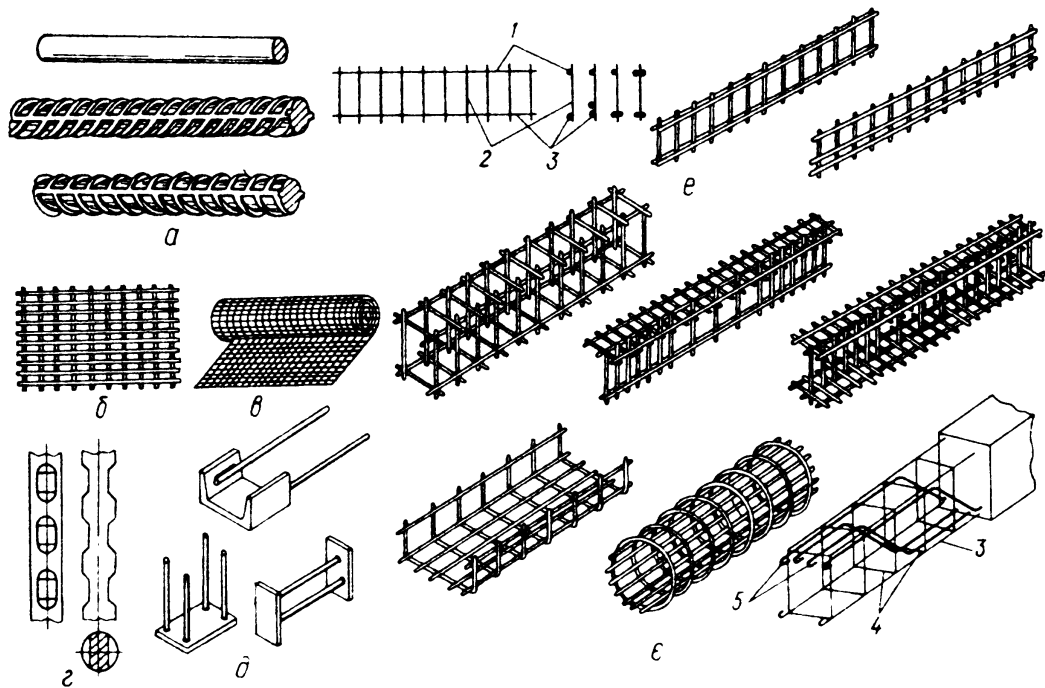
Види арматури: а) арматурні стрижні; б) плоска арматурна сітка; в) рулонна арматурна сітка; г) арматурний дріт періодичного профілю; д) закладні деталі; е) плоскі каркаси; е) просторові каркаси; 1) верхні монтажні стрижні, 2) поперечні монтажні робочі стрижні, 3) нижні робочі стрижні, 4) хомути, 5) кінцеві гаки
